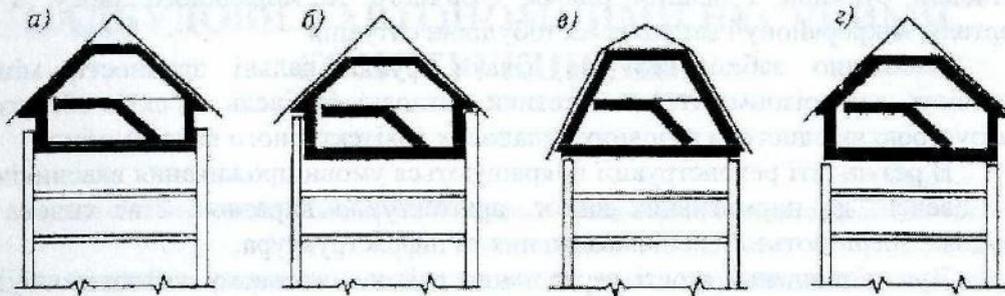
Варіанти влаштування мансард: а – над будинком з технічним верхнім поверхом; б – з влаштуванням двохповерхових квартир; в – з розміщенням двоповерхових квартир під високим дахом; г – суміщення мансарди з надбудовою одного поверху.
